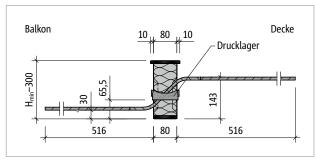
Schöck Isokorb® T Typ QL-V4: Produktschnitt
